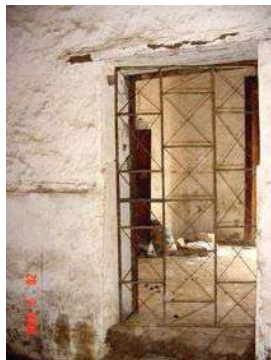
Detalle de puerta de herrería de la Planta Baja.
